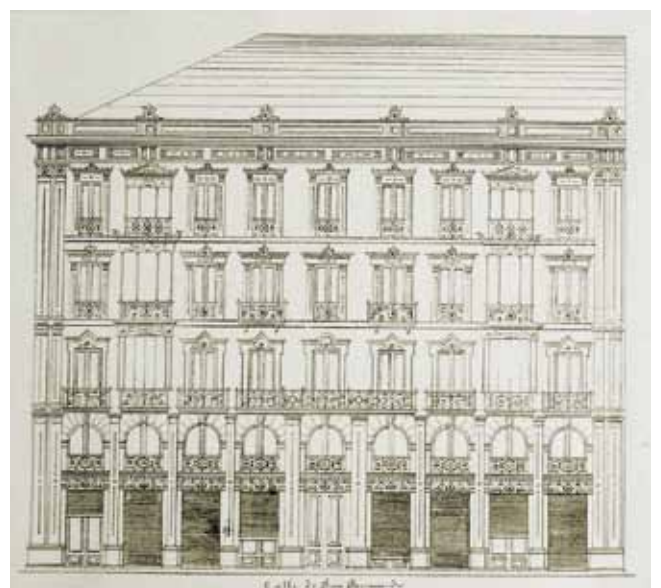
Edificio de Froilán Miranda. Alzado a la calle San Bernardo, Gijón.
